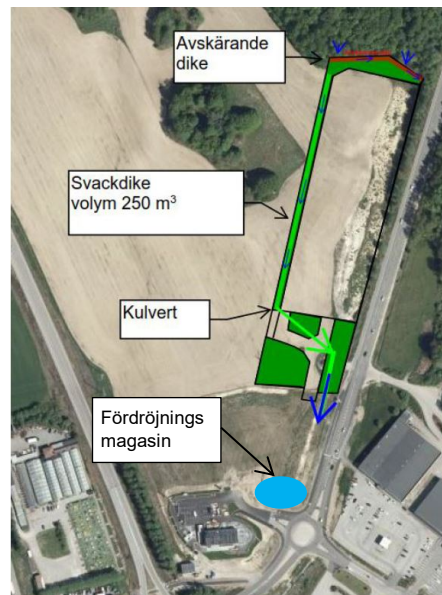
Översiktlig skiss över dagvattenhanteringen i och kring planområdet.
